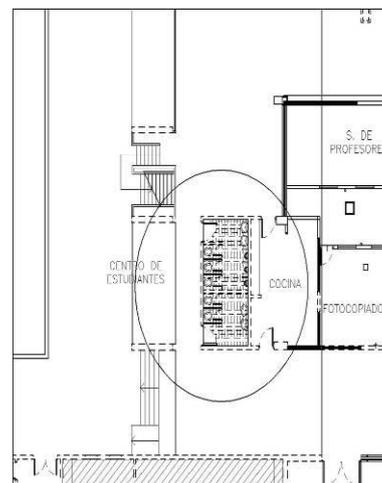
Plano 3 Nivel – 1.35 Plano Baño 2 y 3
